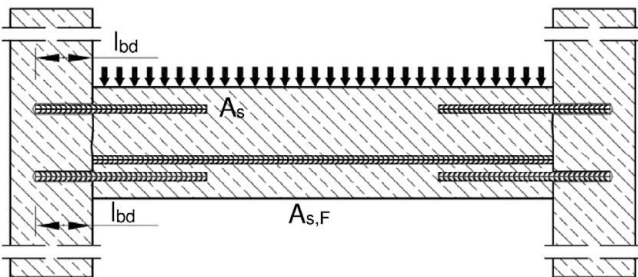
Übergreifungsstoß für Bewehrungsanschlüsse von Platten und Balken
